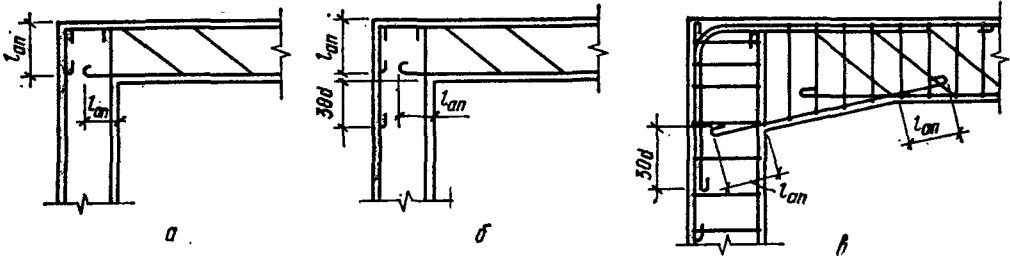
Армирование крайних верхних узлов рам отдельными стержнями:
